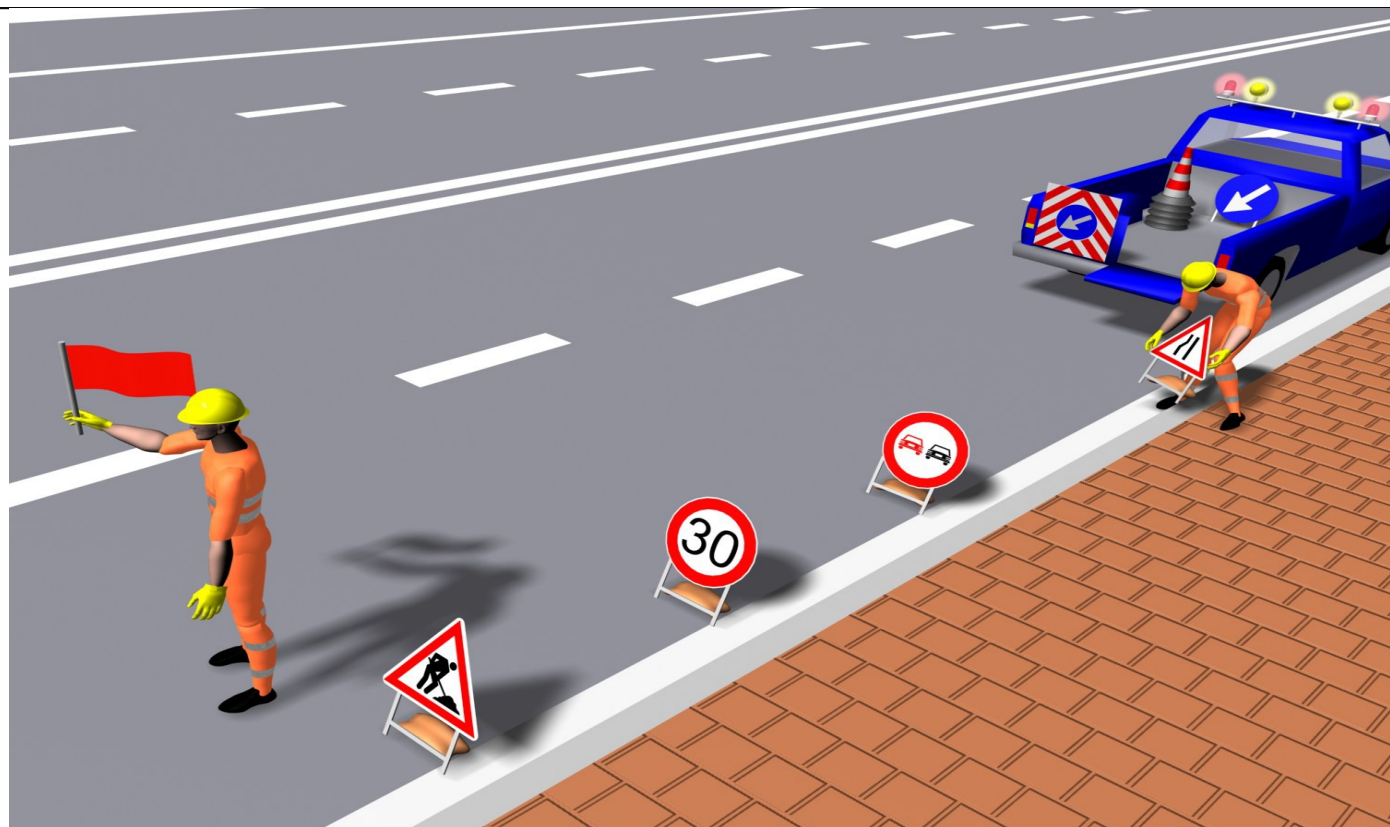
l'addetto alla posa del materiale segnaletico dovrà effettuare la posa stessa avendo cura di tenersi sempre alle spalle il moviere che rallenta il traffico ed avverte l'utenza
